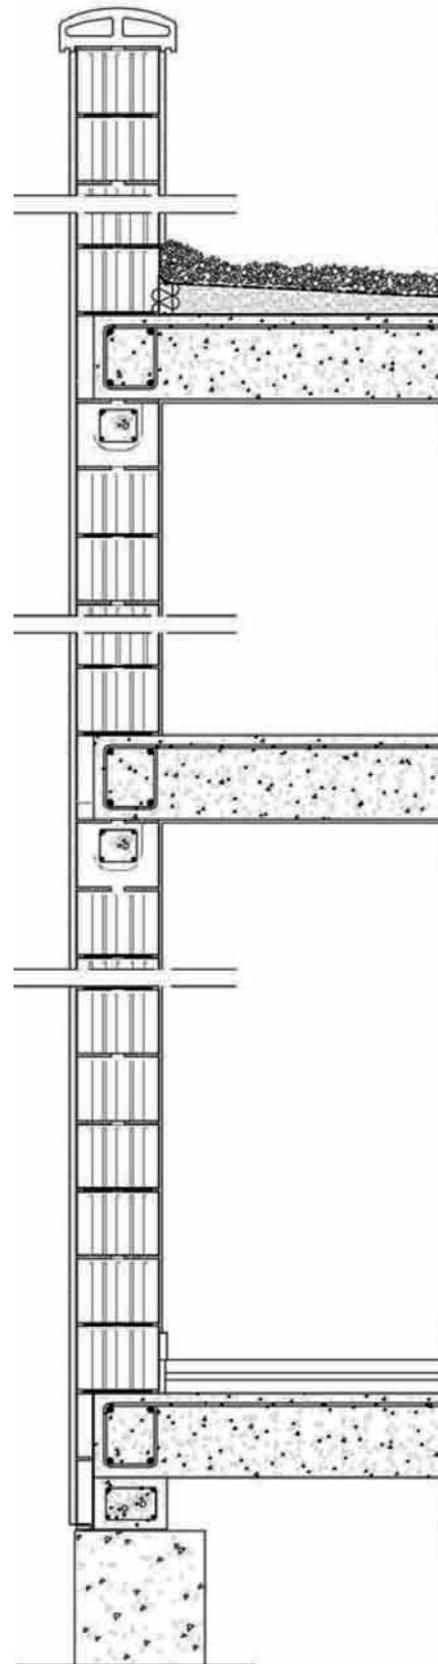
Sección de encuentro de muro de 1 hoja de bloque de árido ligero de carga (Arliblock).
